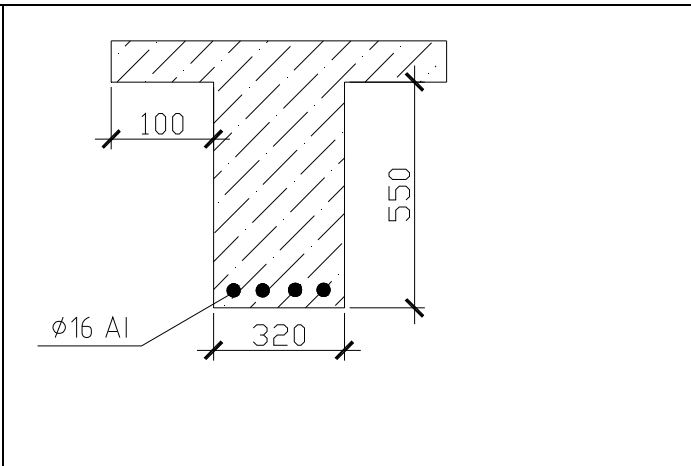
Главная балка ж/б перекрытия над третьим этажом в осях «8–11/Б–В»
